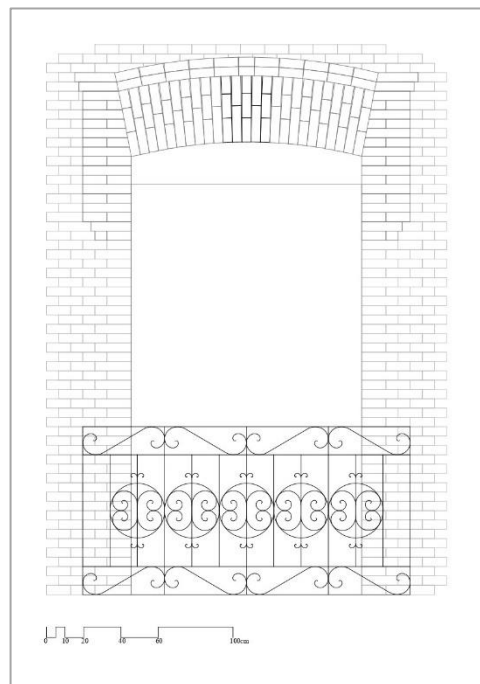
Balcón de la segunda planta del edificio de la avenida de la Albufera 56. Elaboración propia.
